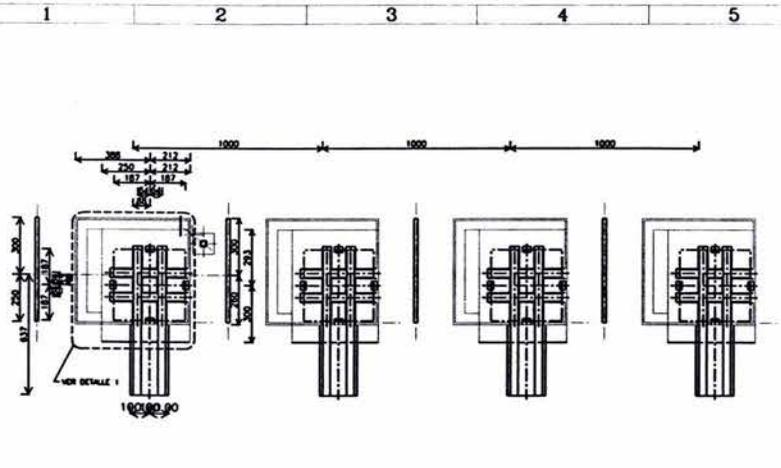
Muro Corta Fuego (proceso constructivo).
